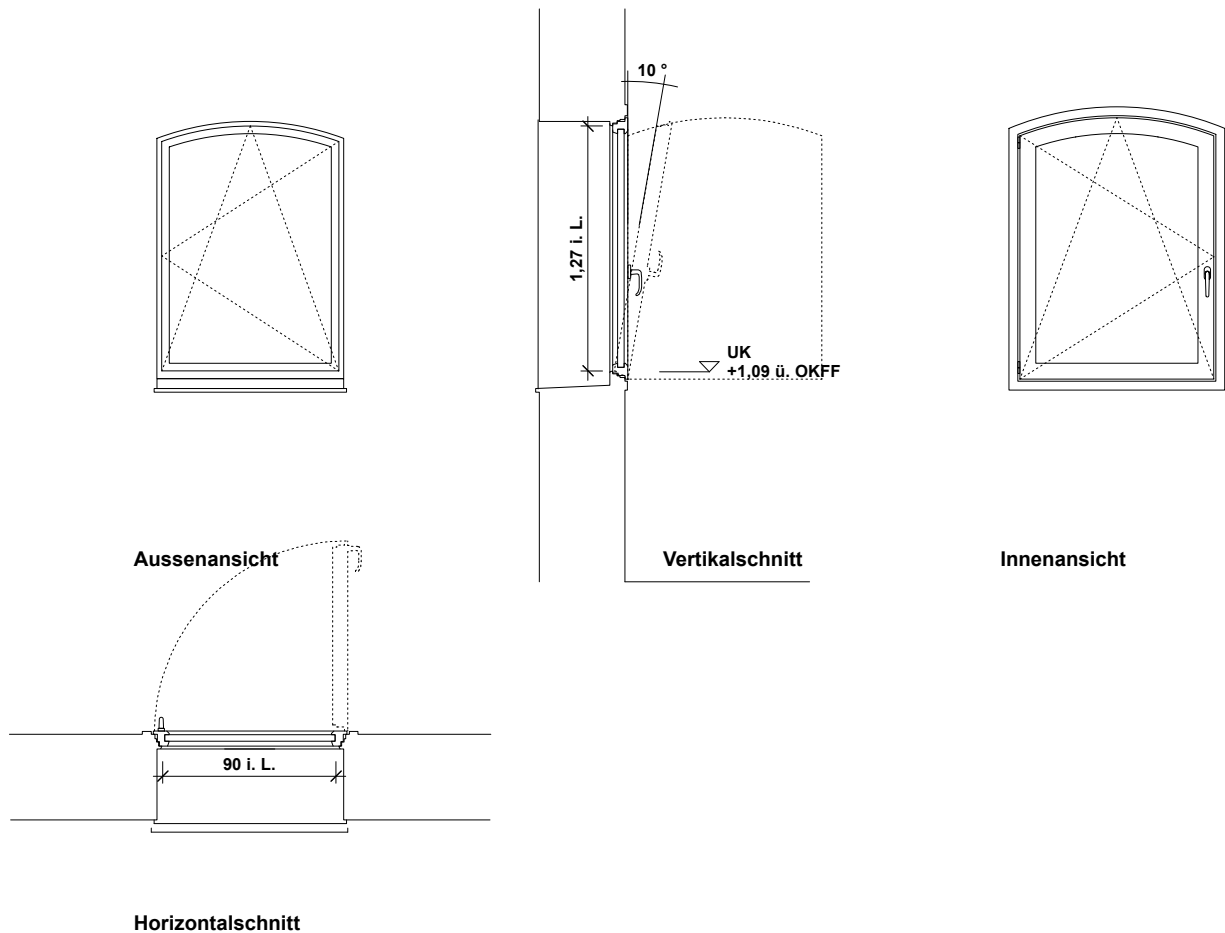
, Detailzeichnung der Fenster, ohne Maßstab, „Mittelgroß“, Gebäude Mauerwerk, Quelle: Tilmann Jarmer, TU München
